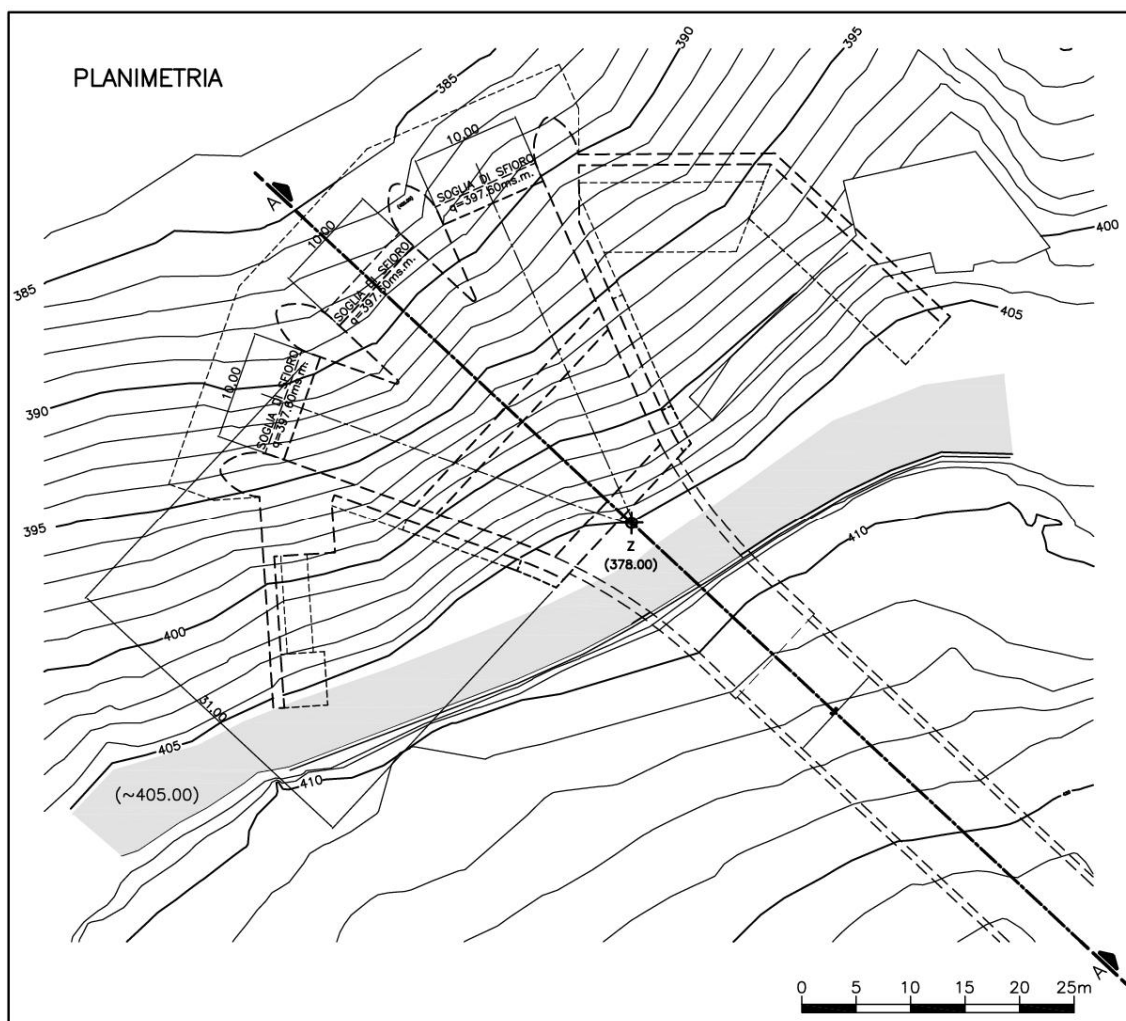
Traccia planimetrica (Profilo A-A) della sezione analizzata
